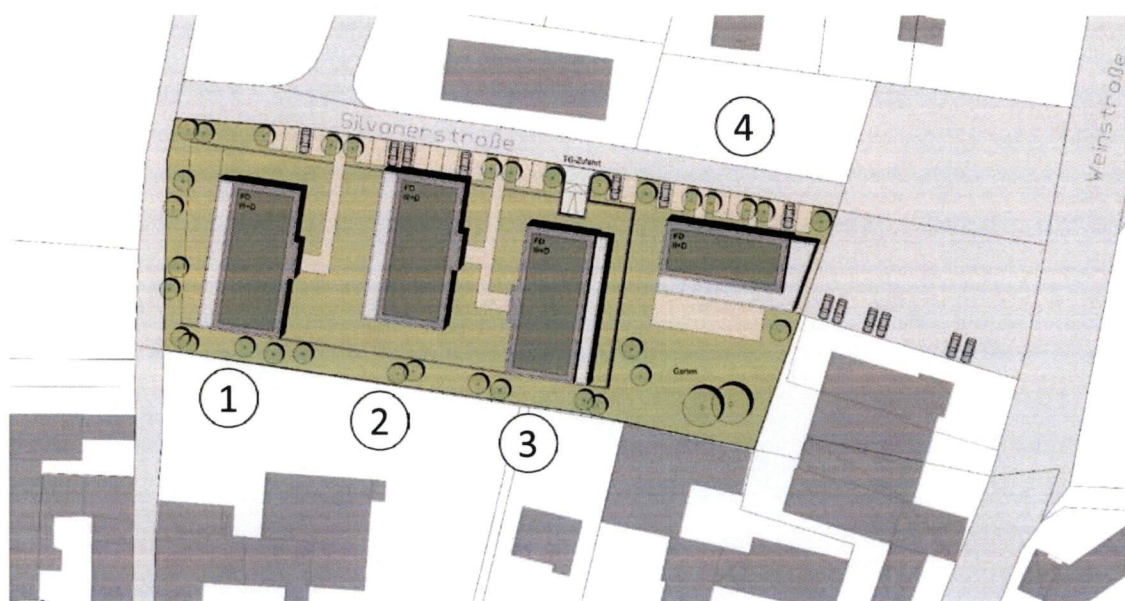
Lageplan mit Anordnung der geplanten Gebäudekörper
